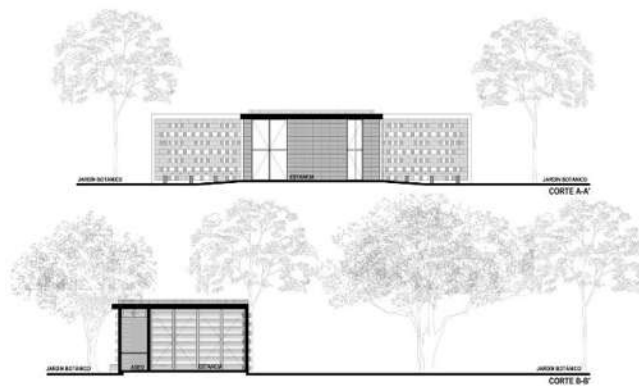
Planta arquitectónica del Centro Comunitario DZÁN, México. Fuente: Archdaily.
